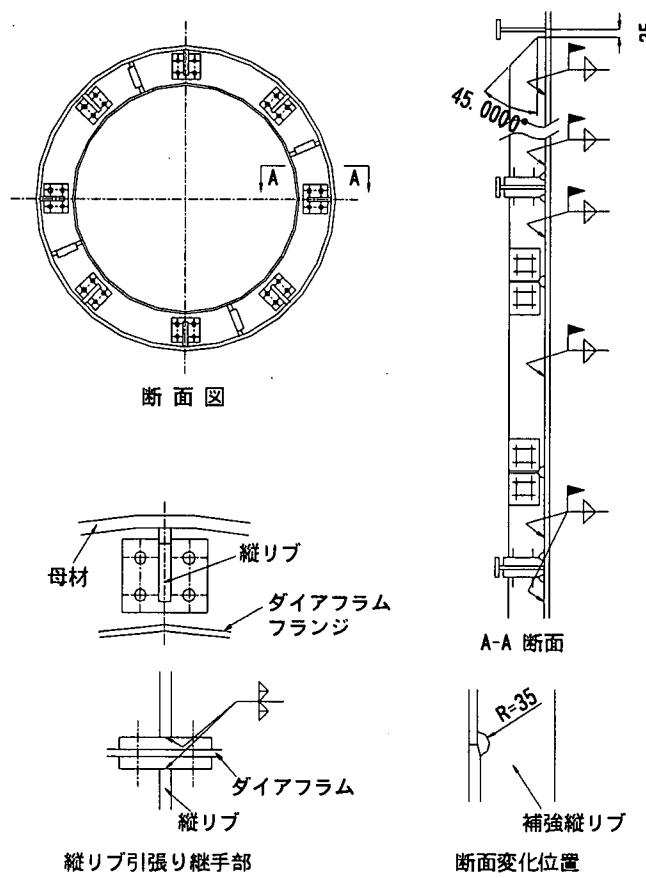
鋼断面補強の参考例（箱形断面－その2）
